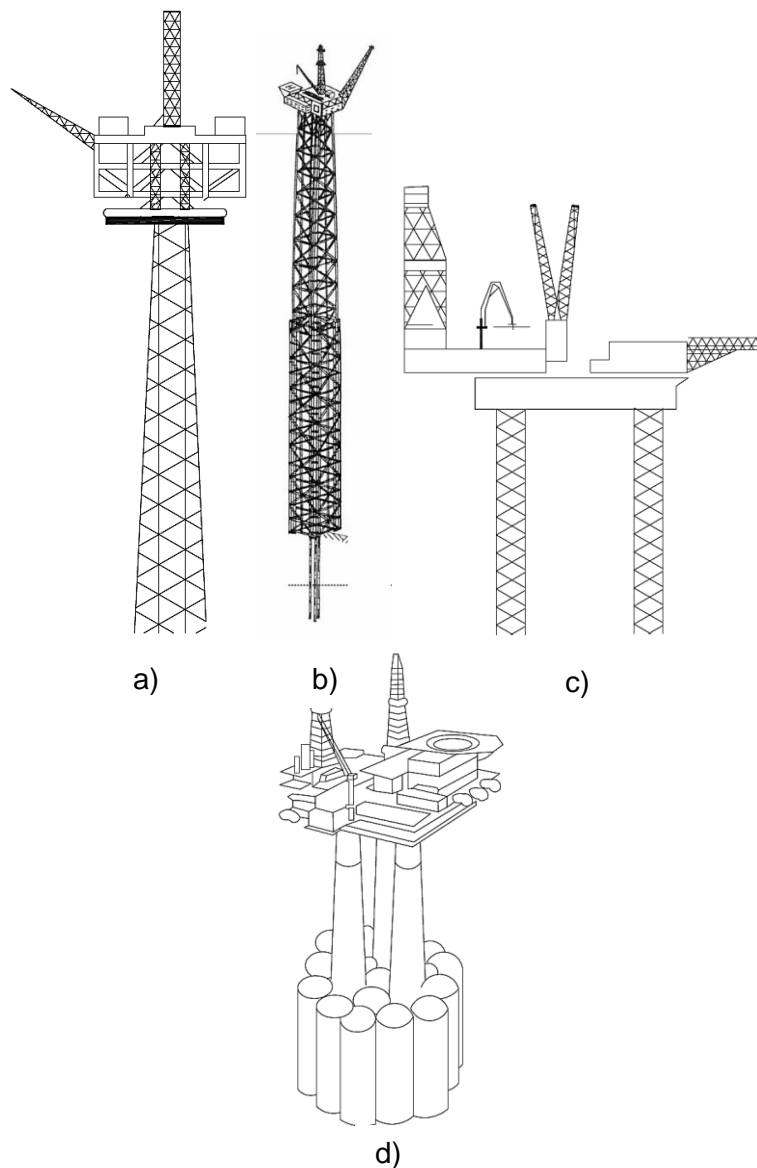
Tipos de estructuras offshore fijas: a) Jacket b) Flexible o Compliant c) Auto elevables o Jack-ups d) De gravedad
